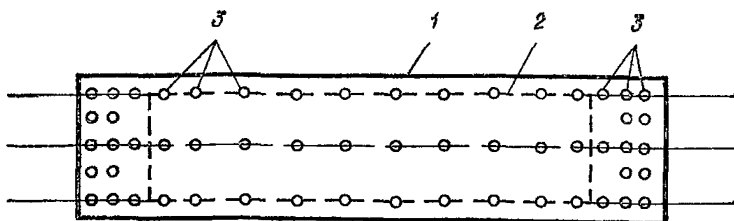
Рекомендуемая схема расположения скважин для замачивания котлованов
